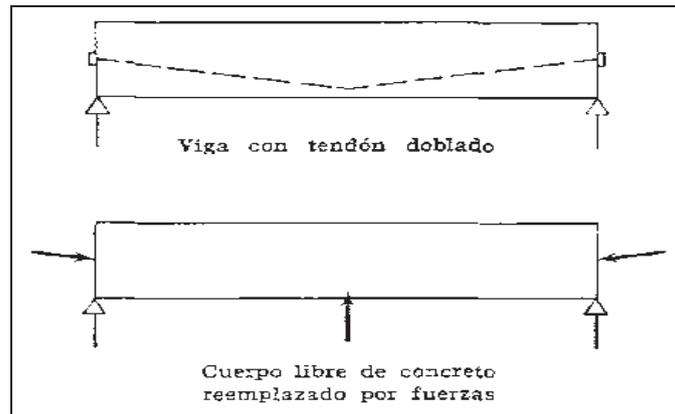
Viga presforzada con tendón o cable doblado [2].
